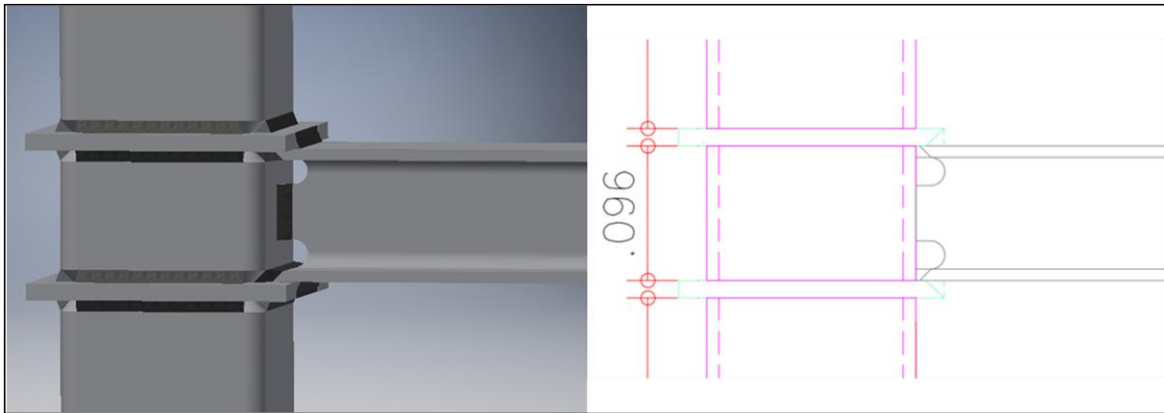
Detalle de soldaduras (gris oscuro) sin contacto en las esquinas para el caso del PTE, las cuales se hicieron por CJP. En adición, se observa el pasa ratones realizado para poder efectuar la soldadura de penetración completa entre la placa de continuidad y el PTE.
